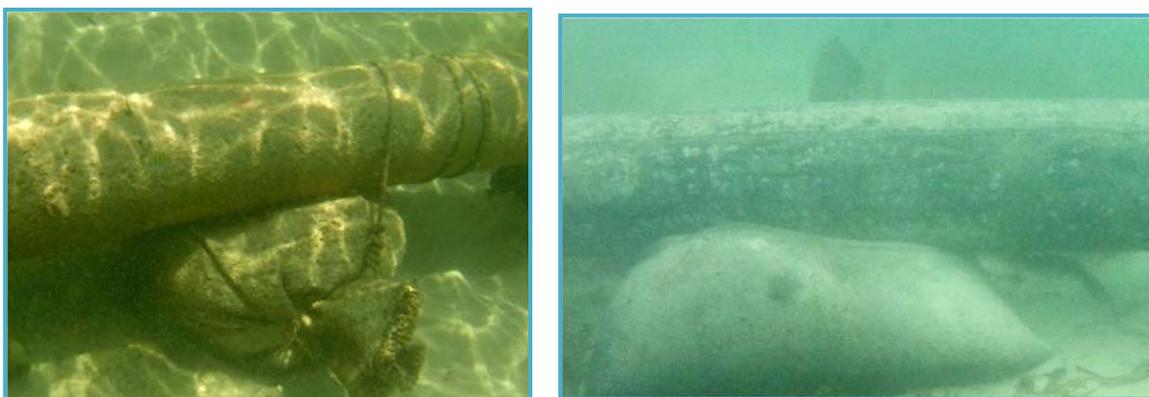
Tuberías y mangueras con lastre de proyectos similares.
